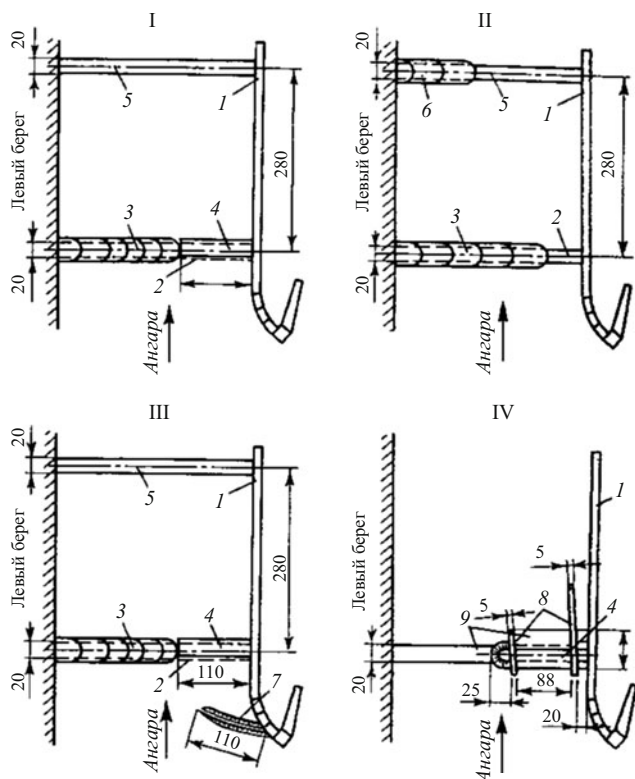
Схемы вариантов перекрытия р. Ангары при строительстве Братского гидроузла:
